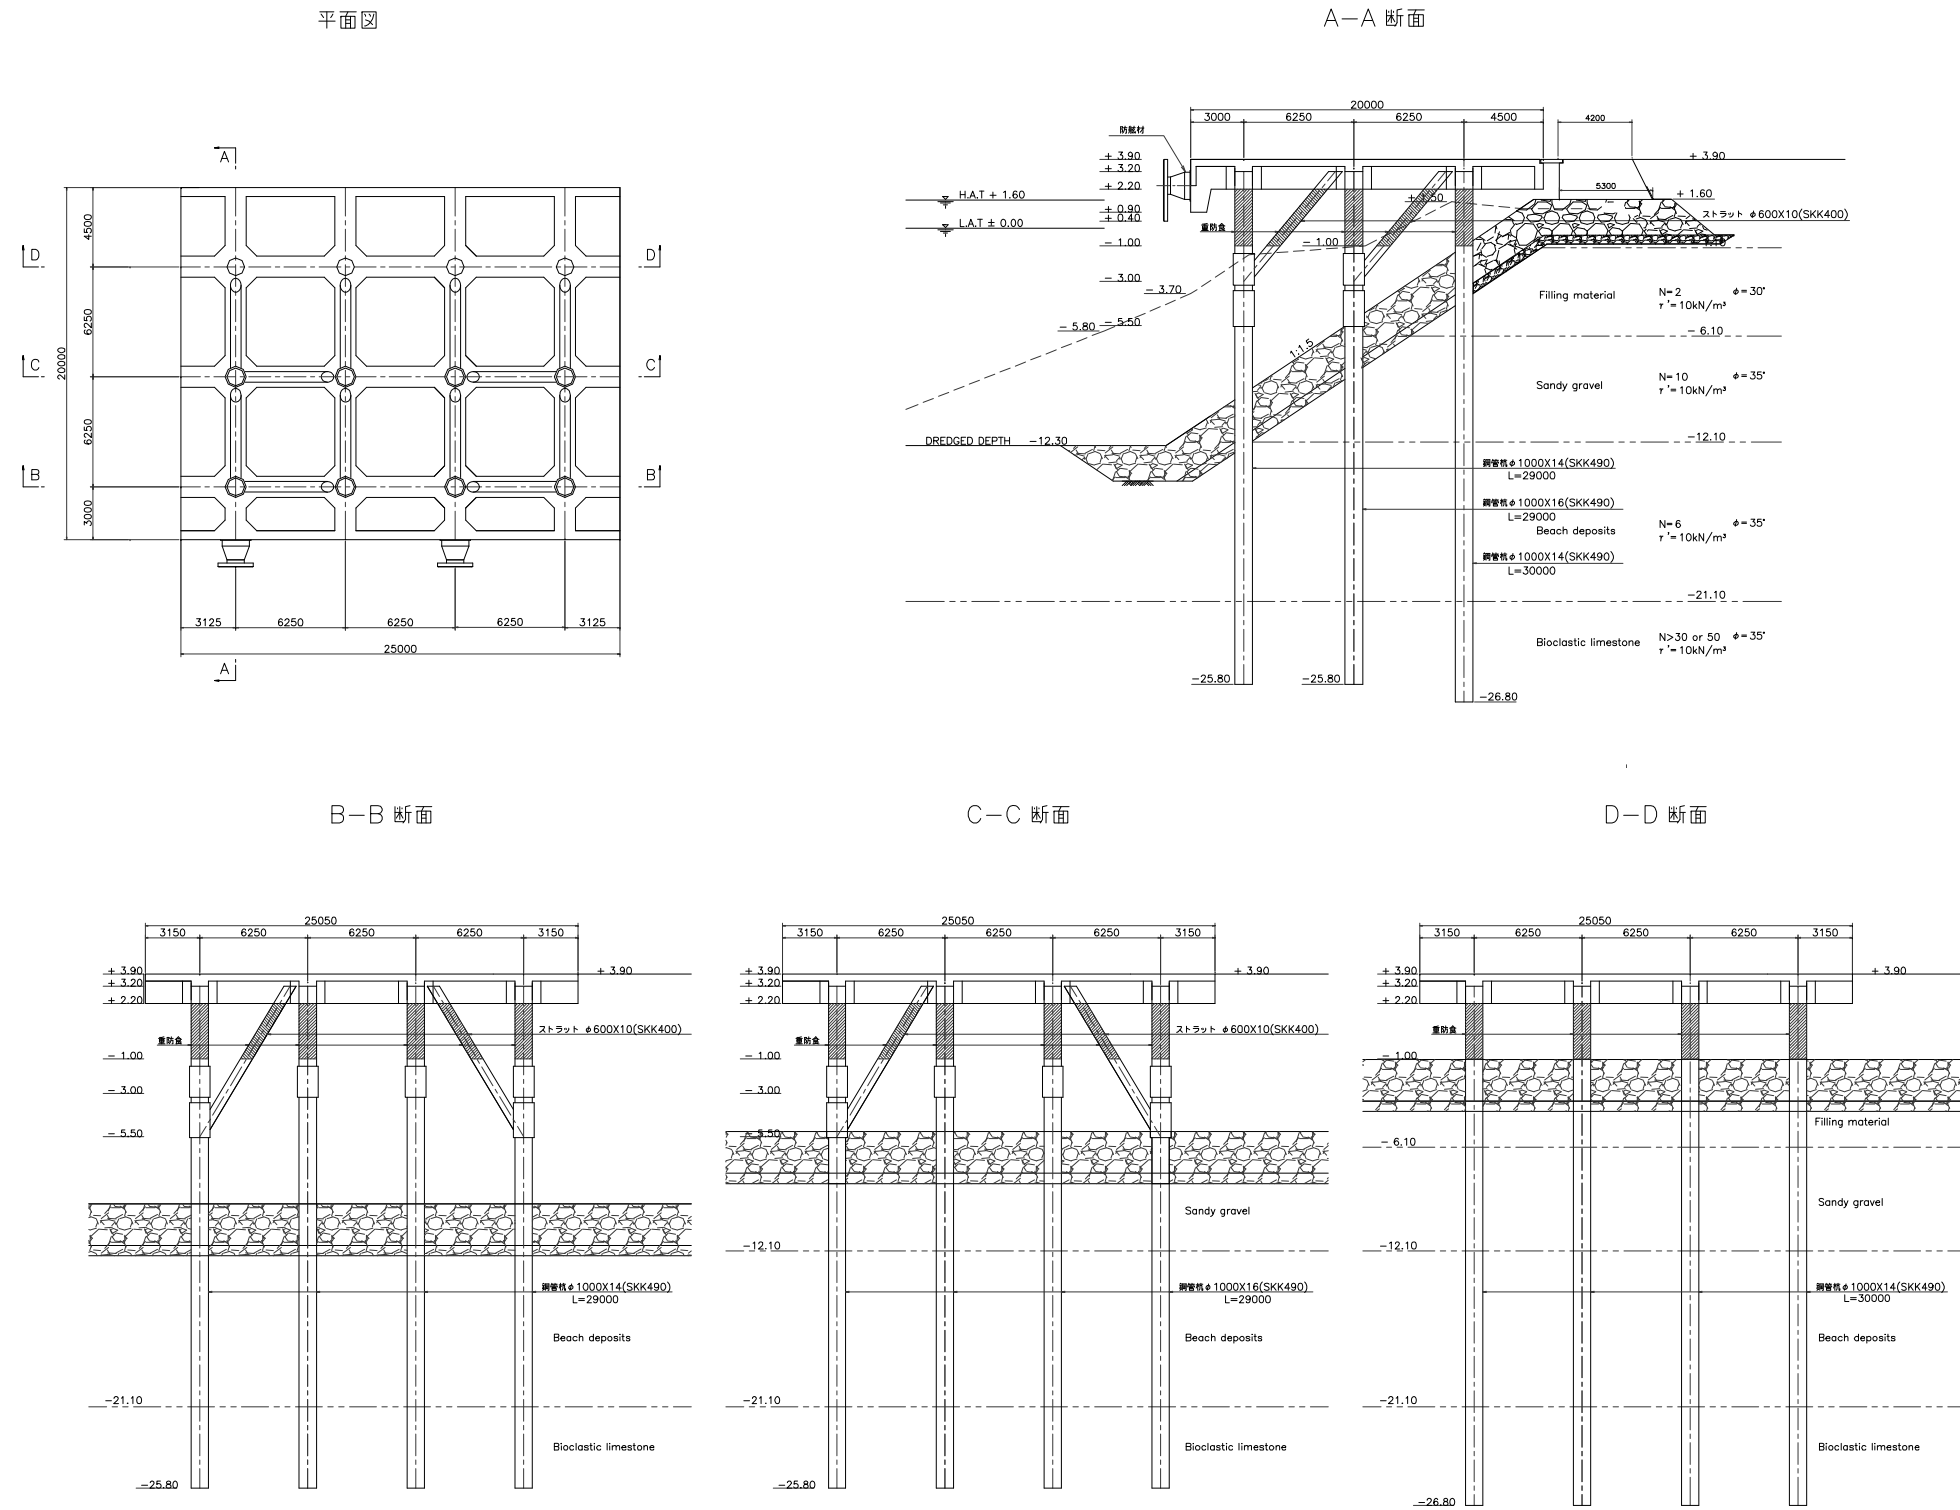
スター埠頭岸壁の標準断面図と平面図
